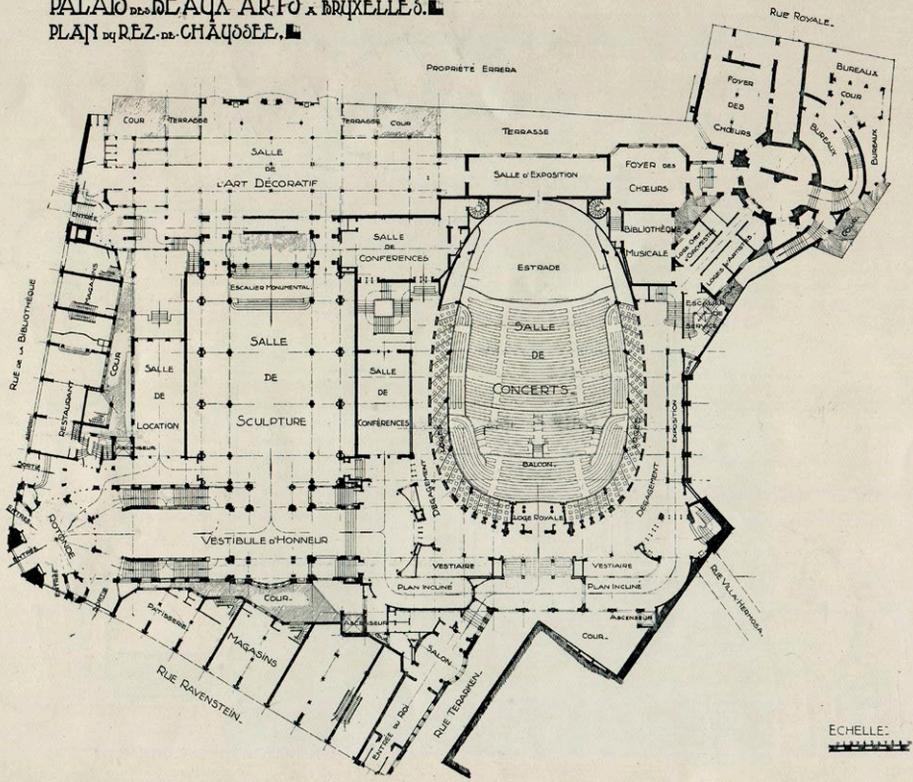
Plan du rez-de-chaussée supérieur (rue Ravenstein).
